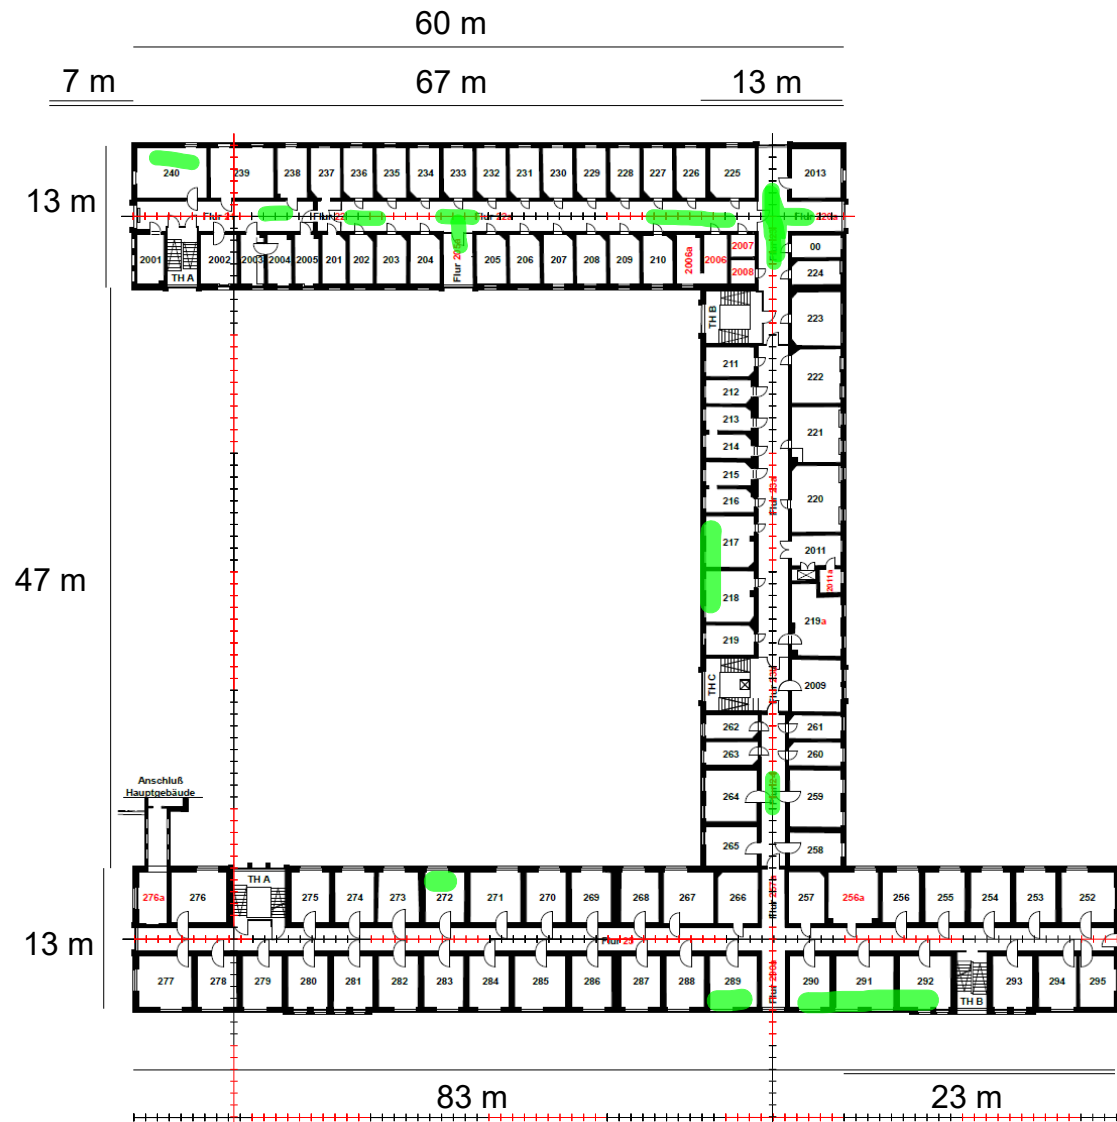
Grundriss des ersten Obergeschosses des Neubaus.
